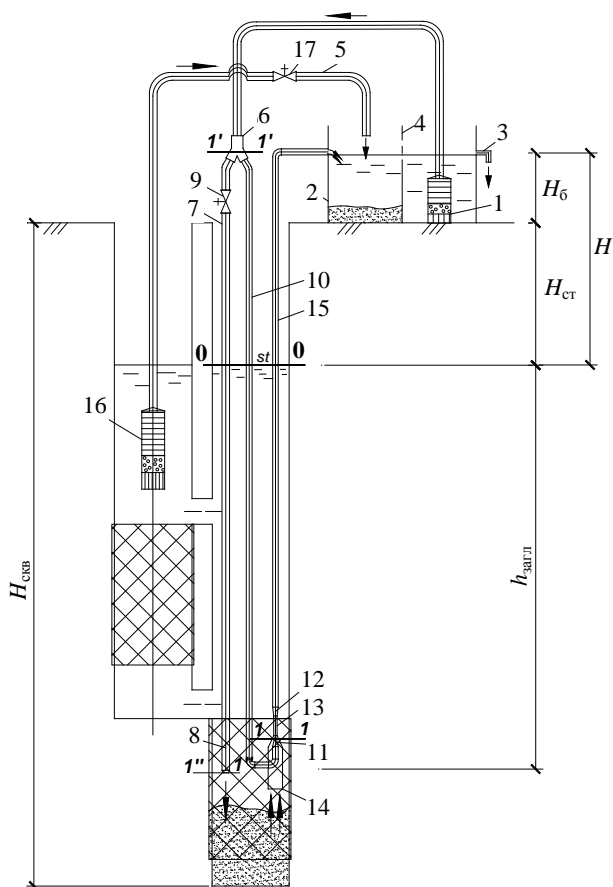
Гидроэлеваторная установка для ремонта двухколонной скважины: 1 – рабочий насос; 2 – бак; 3 – холостой слив; 4 – сетчатая перегородка; 5 – напорный трубопровод; 6 – тройник; 7 – гидромониторный трубопровод; 8 – размывающий конический насадок; 9 – вентиль на гидромониторном трубопроводе; 10 – подводящий трубопровод; 11 – рабочее сопло; 12 – диффузор; 13 – камера смешения; 14 – всасывающий патрубок насоса-гидроэлеватора; 15 – пульповод; 16 – погружной насос; 17 – вентиль на напорном трубопроводе
